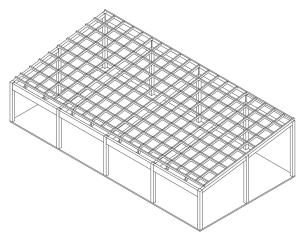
Axonometría estructural tipo 1_7 Fuente: Autores, 2024
